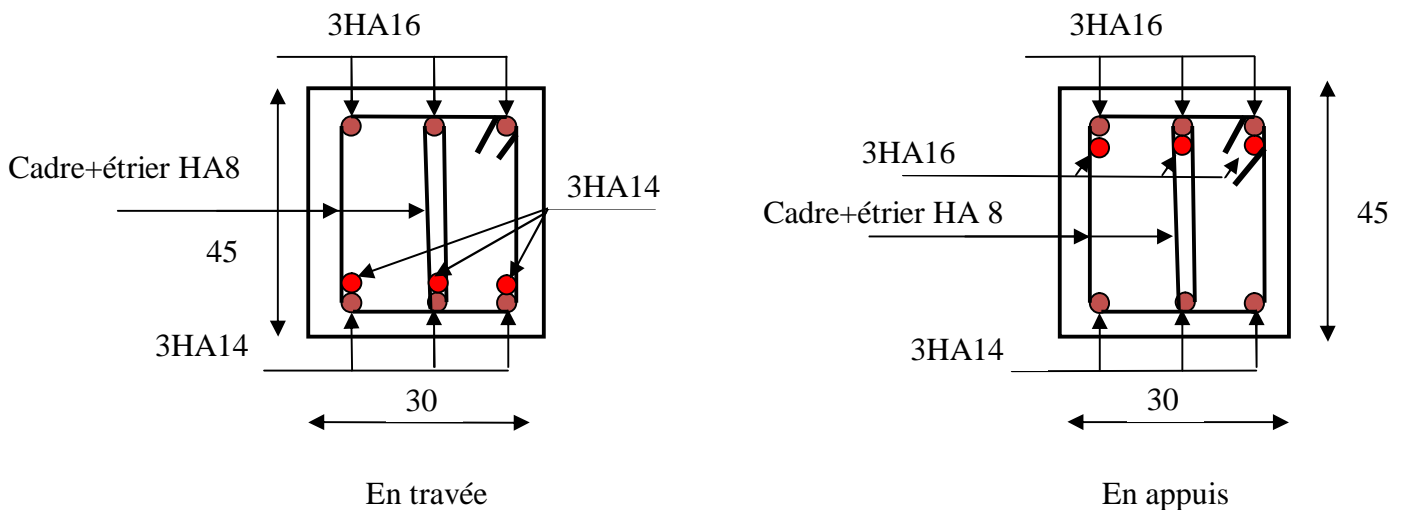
Schéma de ferrailage de la poutre principale RDC+SP.
